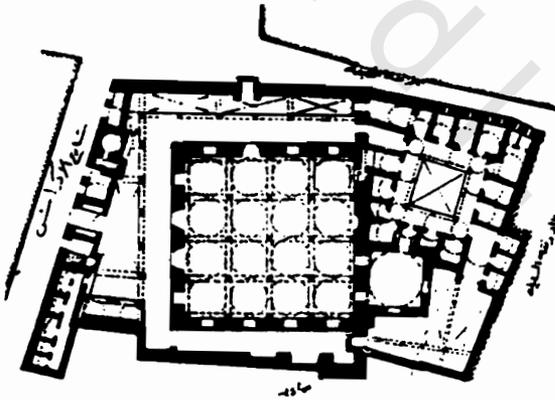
مسقط أفقي لجامع خليل باشا (١١٢٠هـ/١٧٠٨م)
